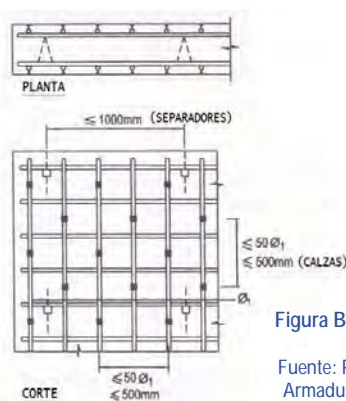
COLOCACIÓN DE SEPARADORES Y CALZAS EN MUROS
